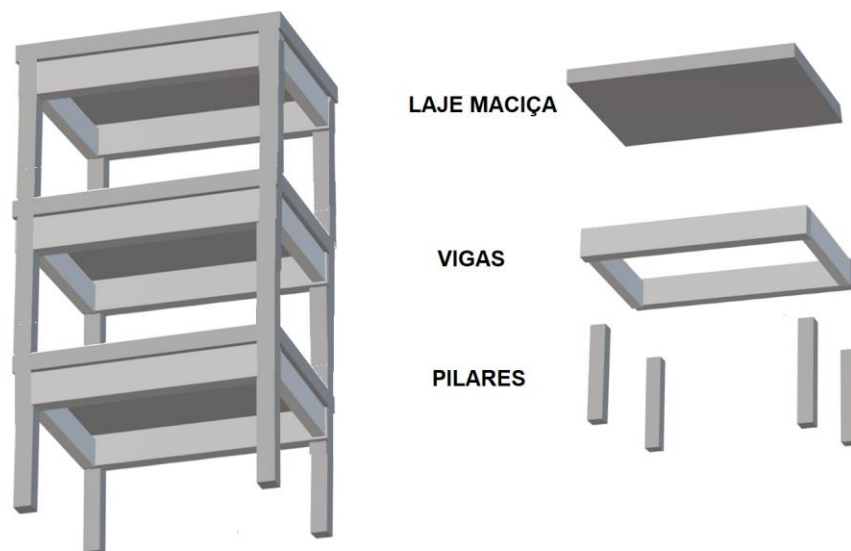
Edificação de concreto convencional com lajes maciças, vigas e pilares.
